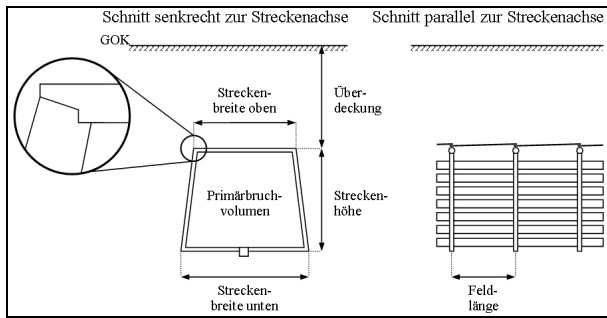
Schematische Darstellung einer typischen Strecke mit Holzausbau (Paralleltrapez).
